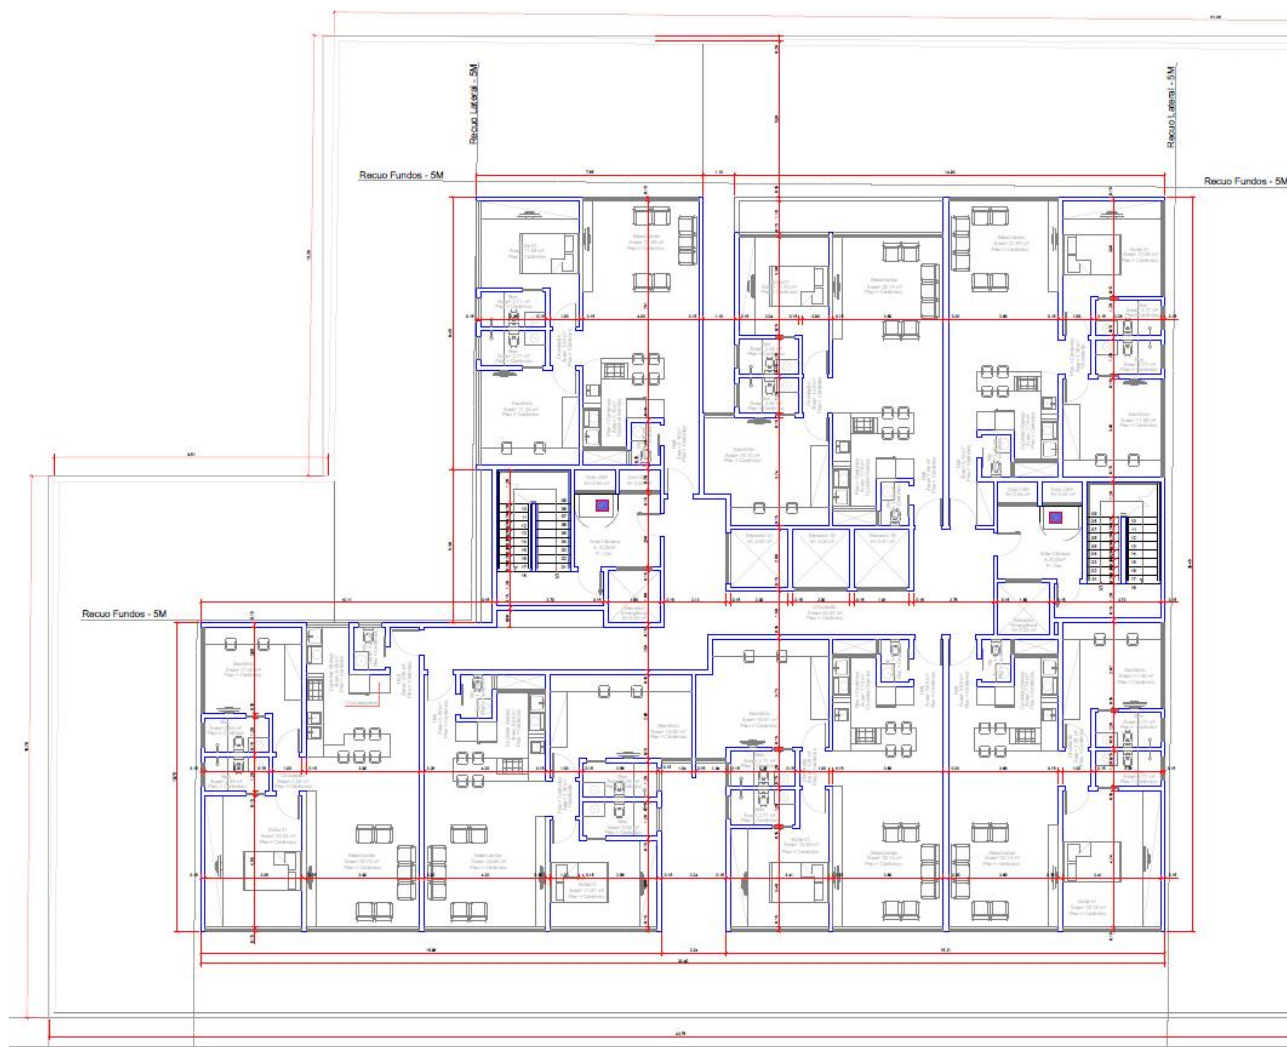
Planta Baixa - Pavimento Tipo 01 (x17) - Área: 649,29m² x 17 = 11.037,93m².
